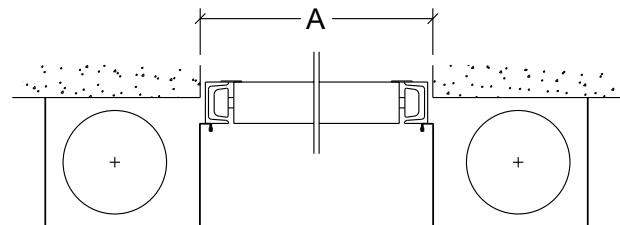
Detalle en planta de puerta industrial basculante con forros..
